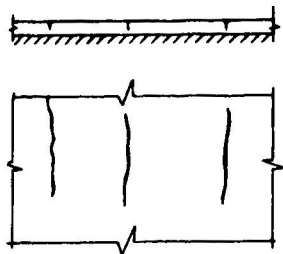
Grieta por retracción plástica en una losa de pavimento.
